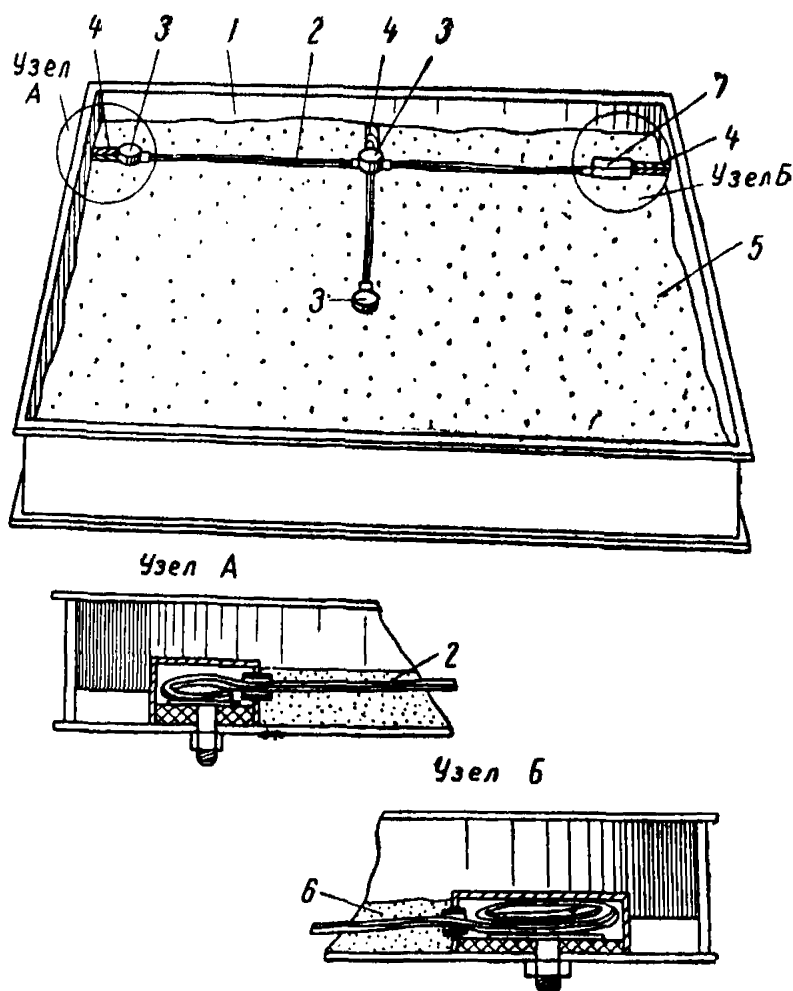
Замоноличивание электропроводки в стеновую шлакобетонную панель, изготавливаемую в горизонтальной форме
